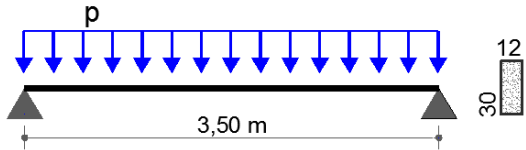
Subgrupo VB-G51: geometria e carregamento
